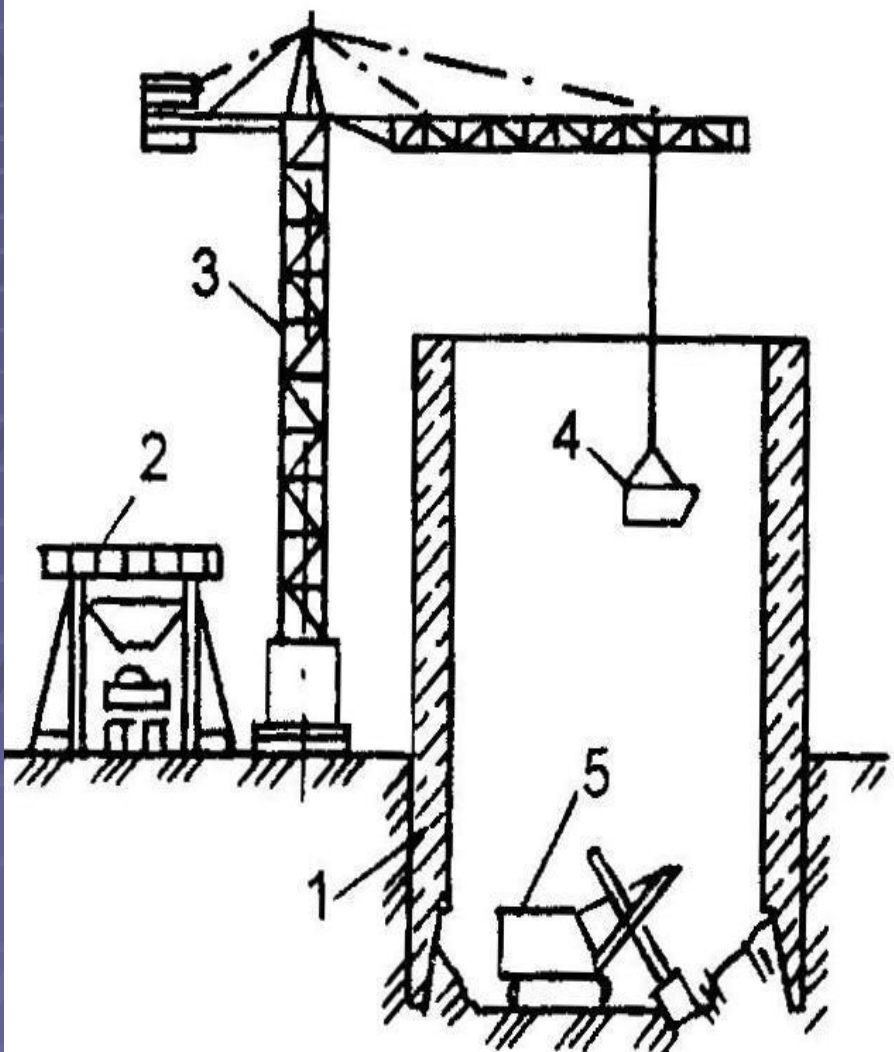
Схема разработки грунта с использованием экскаватора и башенного крана:
